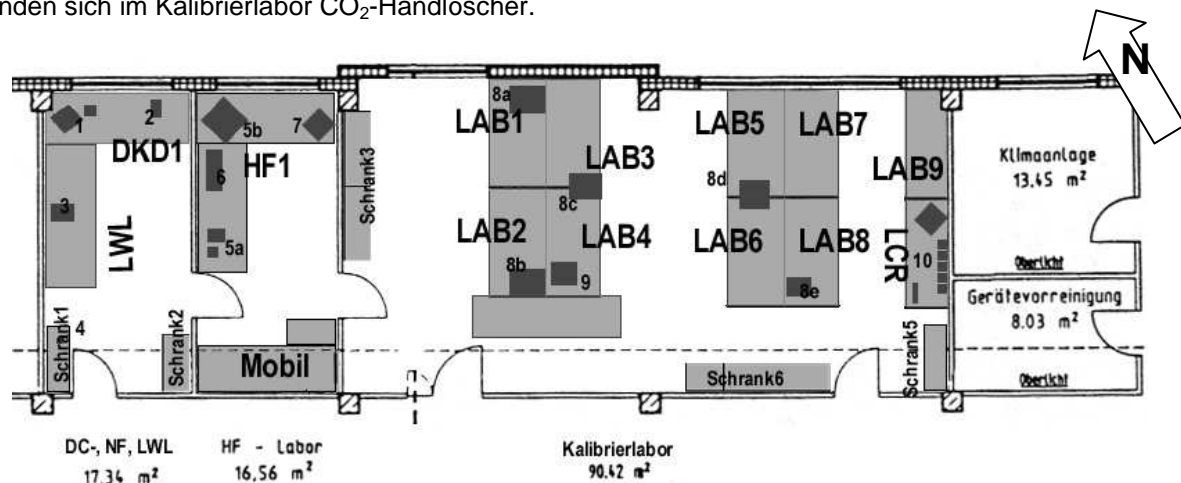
Raumplan Laborbereich, elektrisch:
